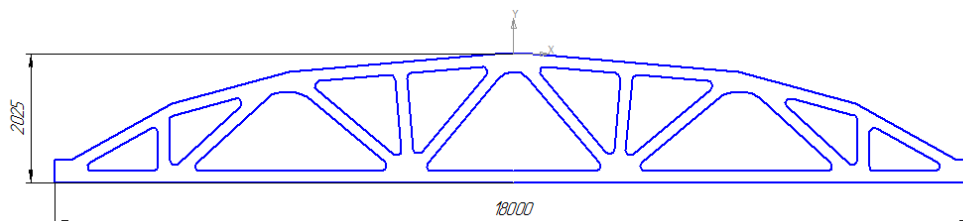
Габаритные размеры железобетонных ферм
